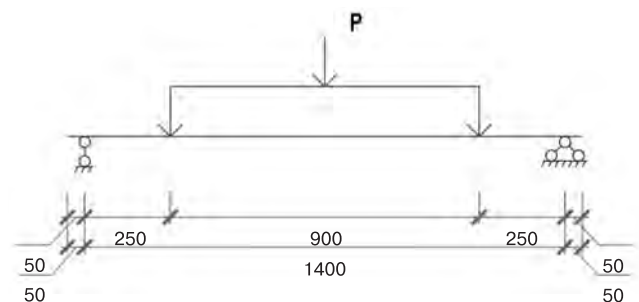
Схема испытаний партий образцов с шифрами 1.1-2; 1.1-4; 1.2-2 и 1.2-4
